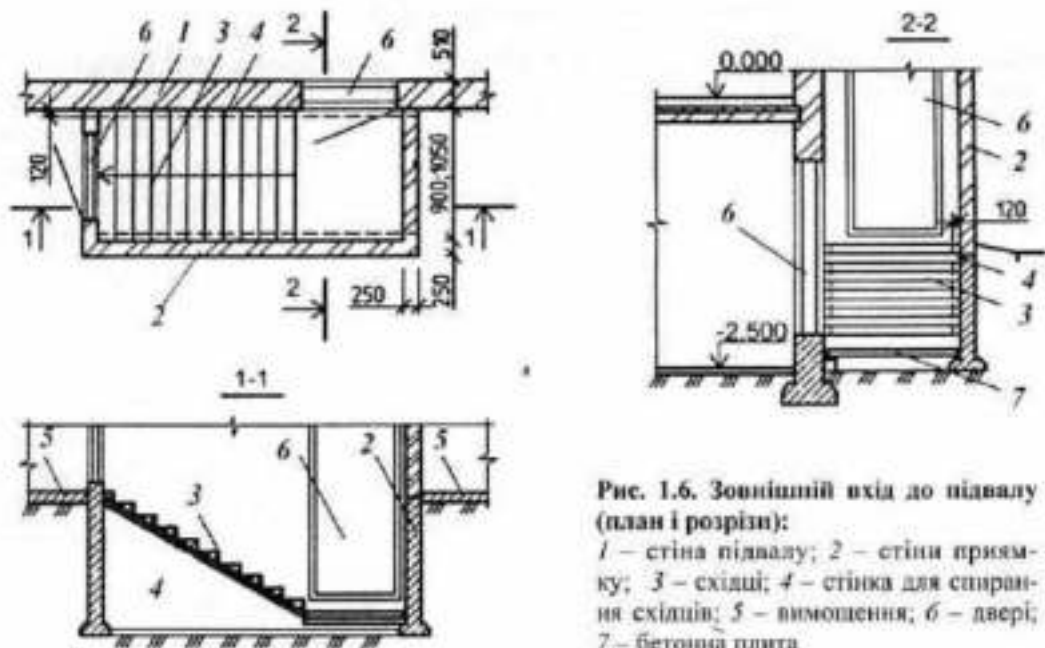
Зовнішній вхід до підвалу (план і розрізи):
